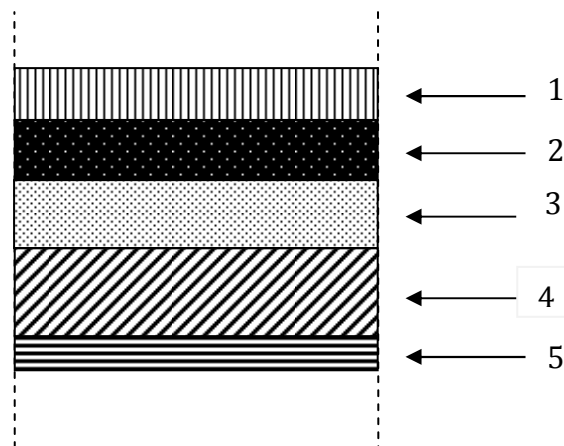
Coupe verticale d'un plancher du balcon.
